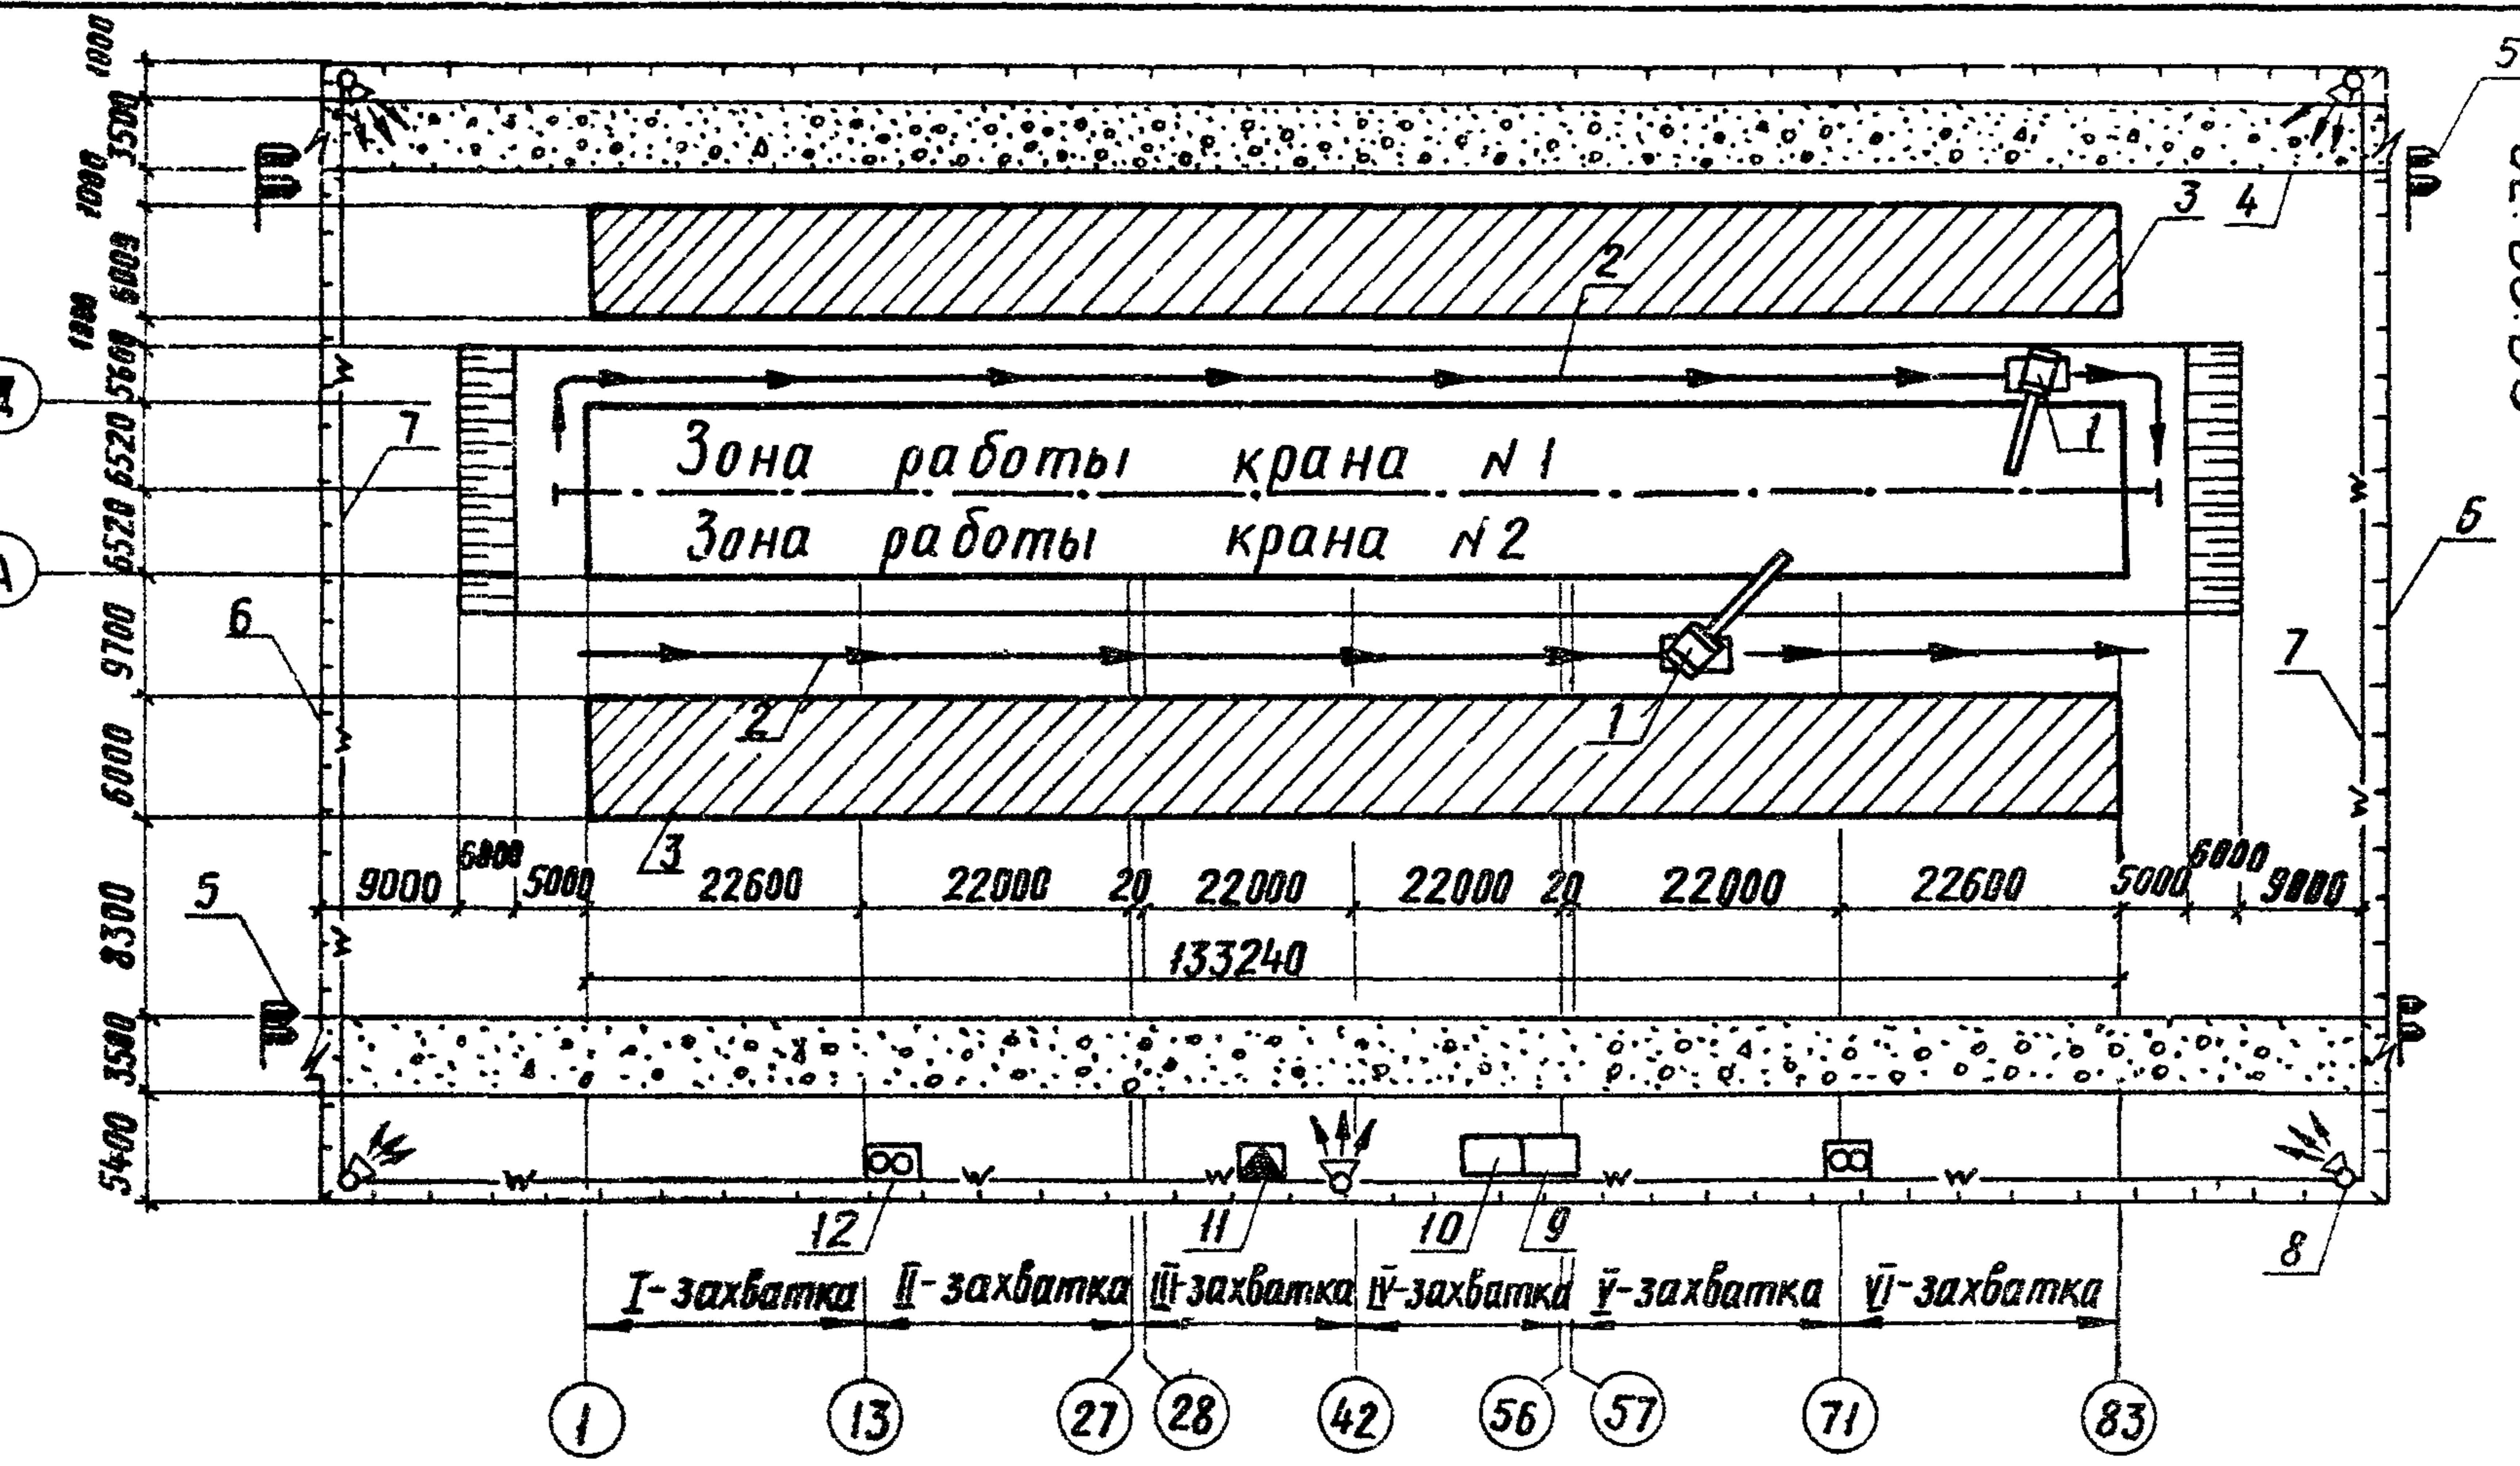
Рис. I. Схема организации строительной площадки: I-краны К-16I; 2-оси проходов кранов; 3-площадки складирования материалов и конструкций; 4-временный проезд; 5-знаки "Берегись автомобиля" и "Посторонним вход воспрещен"; 6-временное ограждение; 7-кабель 380в; 8-проекторная машина; 9-бытовое помещение; 10-конторы производителя работ; II-трансформаторная подстанция КПП-180; 12-туалет
